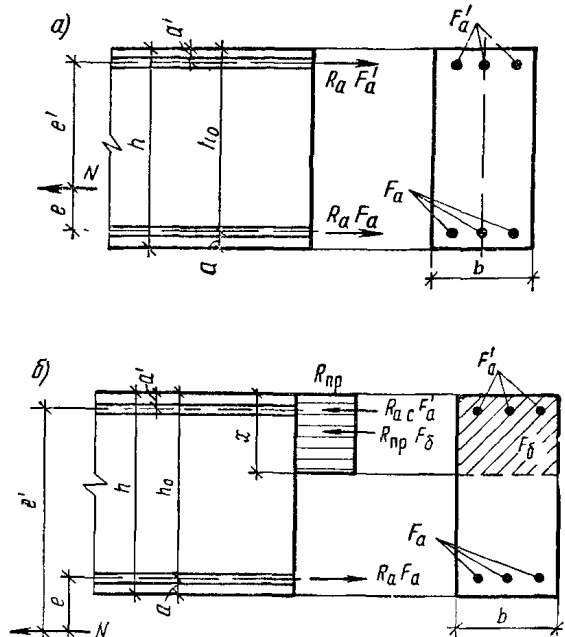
Схема усилий и эпюра напряжений в сечении, нормальном к продольной оси внецентренно-растянутого железобетонного элемента, при расчете его по прочности
